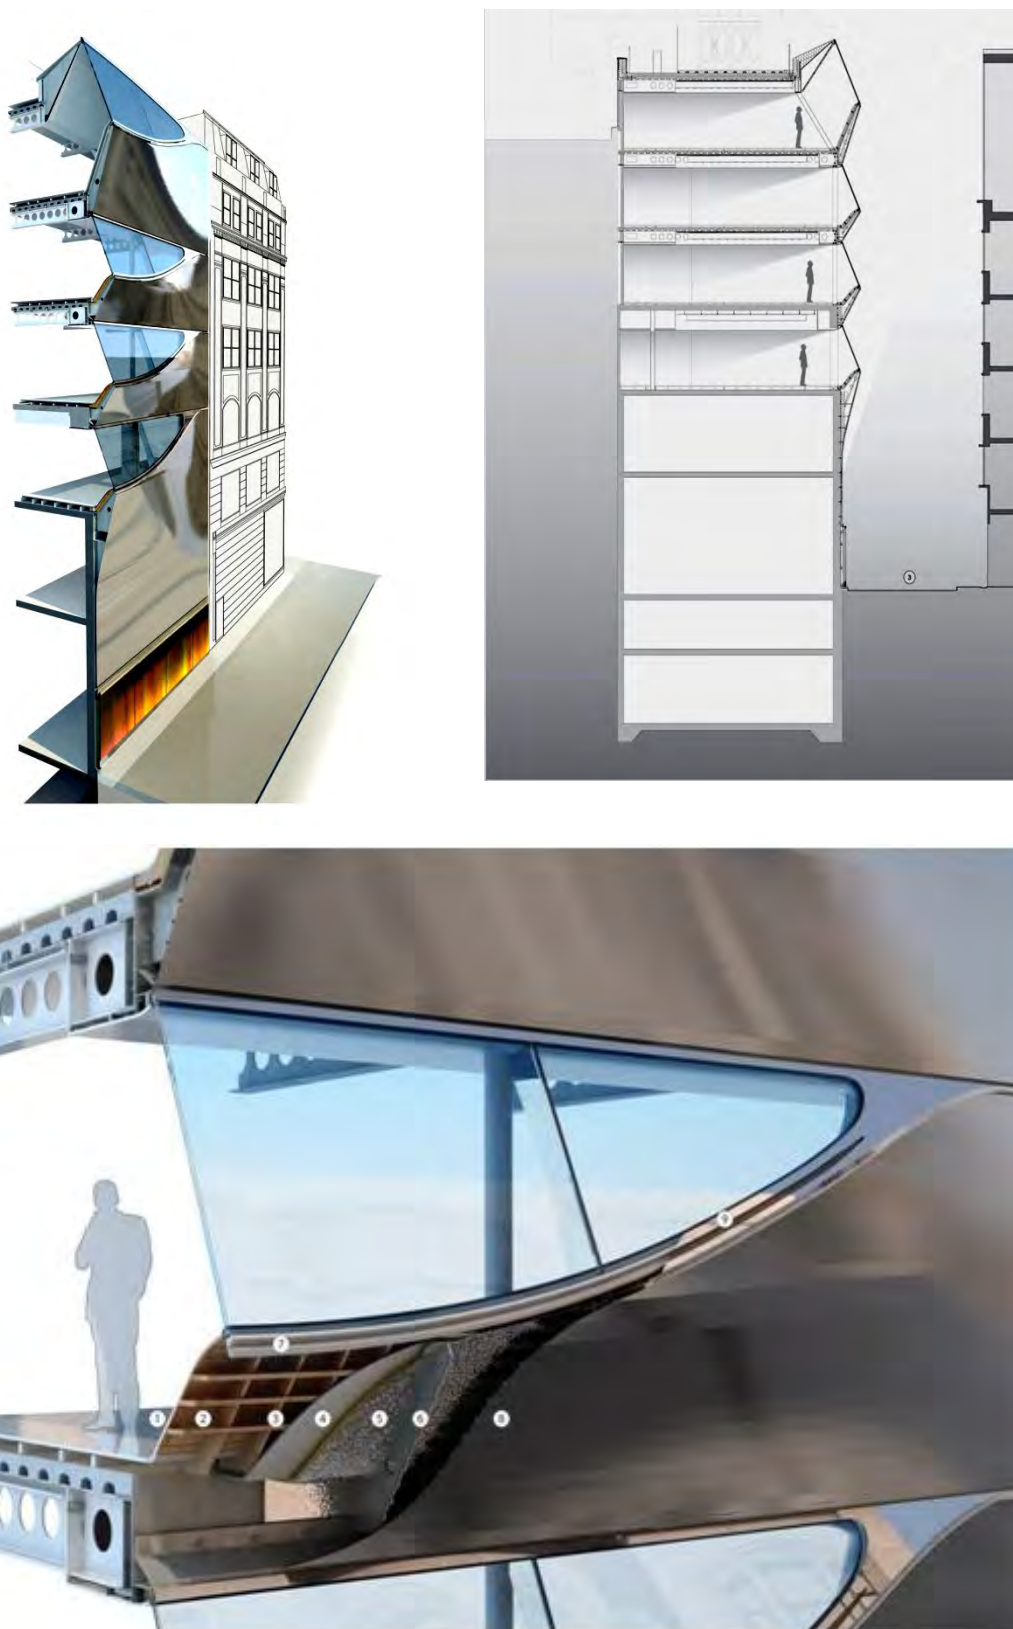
Разрезы и конструкции фасада в стадии разработки: 1 – композитная обшивка с тонкослойным синтетическим покрытием, кремневодородной обработкой поверхности; 2 – обшивка гибкой фанерой, прошедшей обработку теплом и давлением; 3 – каркасы из фанеры; 4 – цементностружечная плита ЦСП; 5 – теплоизоляция; 6 – рёбра из оцинкованной стали; 7 – втиснутый водосточный желоб из нержавеющей стали; 8 – алюминиевая облицовка фасада; 9 – полированные накладки-молдинги из нержавеющей стали
